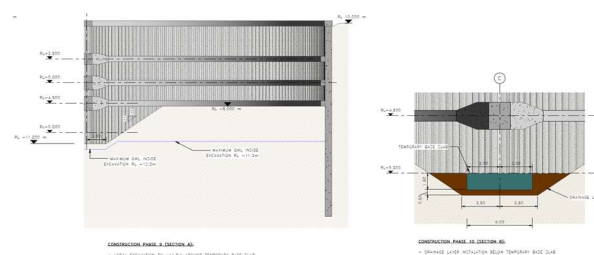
Excavación para la ejecución del apuntalamiento inferior en la zona de intersección de los cilindros
